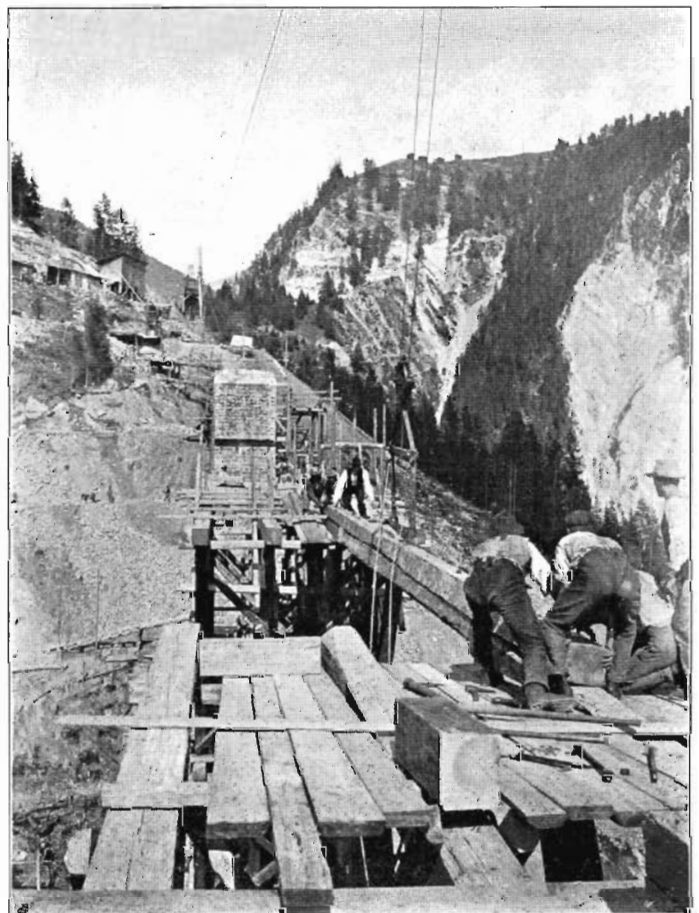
Schliessen der vorgebauten Teile des Lehrgerüsts über der Mittelöffnung. — Erbauer Zimmermeister *R. Coray* in Trins.
